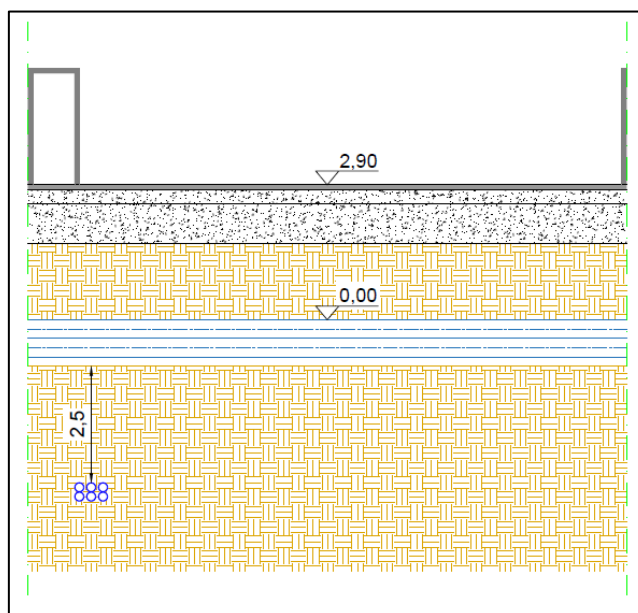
Sezione tipo (estratto coldLI-PD-EG15-06-REV00)
